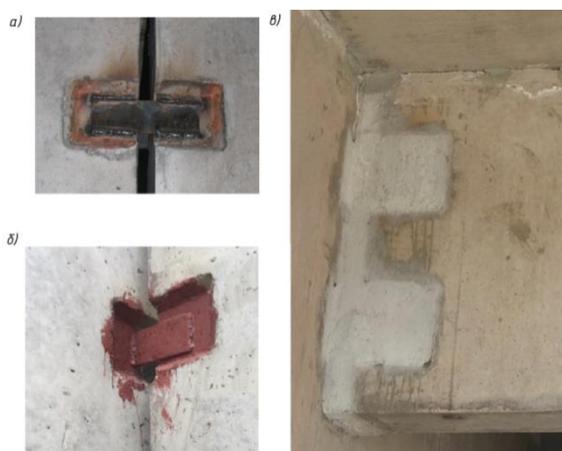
Примеры вертикального сварного соединения стеновых панелей.
